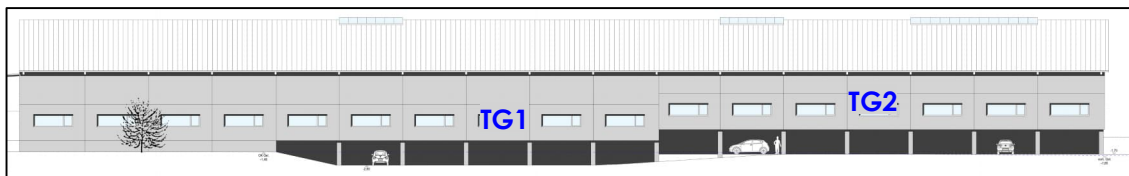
Auszug aus der Eingabeplanung zum Anbau einer Lagerhalle mit Schlosserei und Tiefgarage mit Kennzeichnung der Parkebenen /25/
